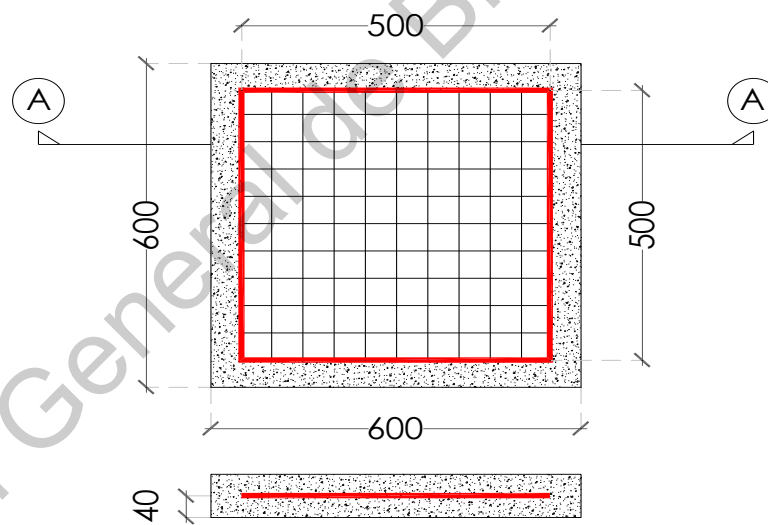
Detalles del acero de refuerzo usado, vista en planta y sección A-A.
